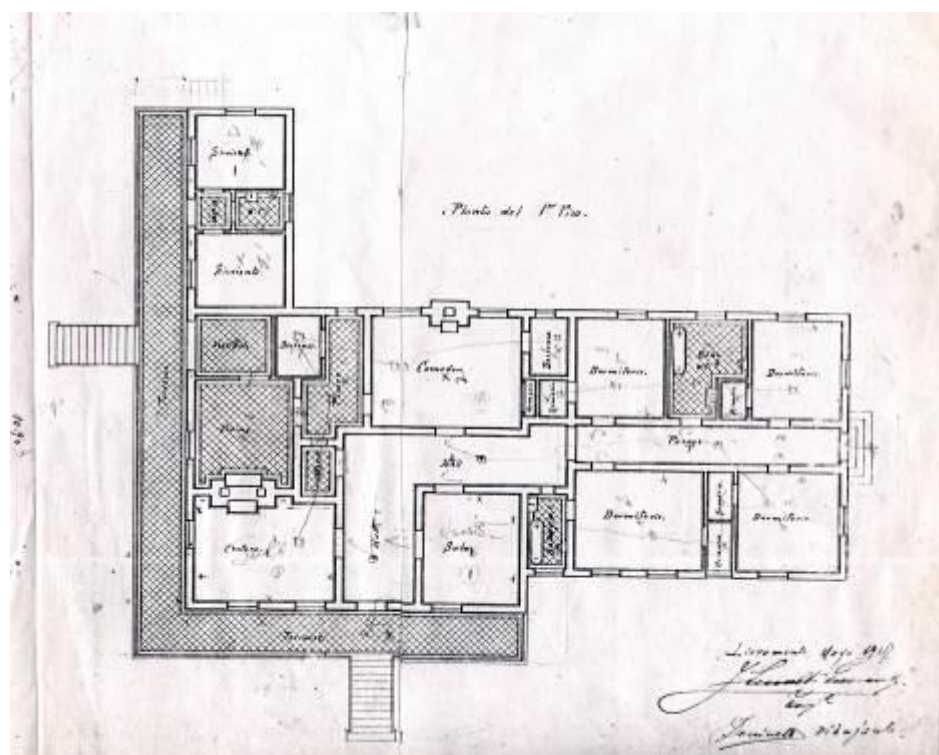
Compañía Armour do Brasil. Casa del Superintendente. Planta baja 1 piso. Mayo de 1917.
